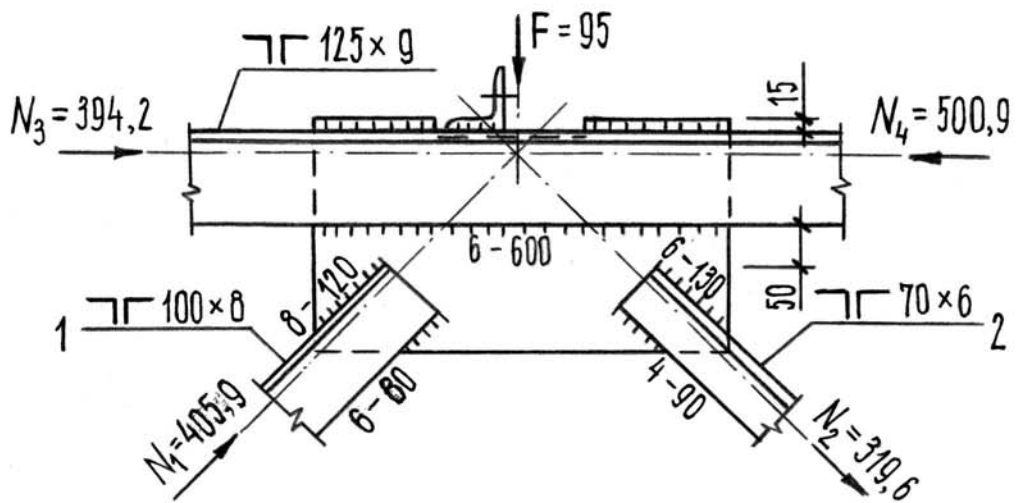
Узел сопряжения верхнего пояса фермы с раскосами (пример 1)
